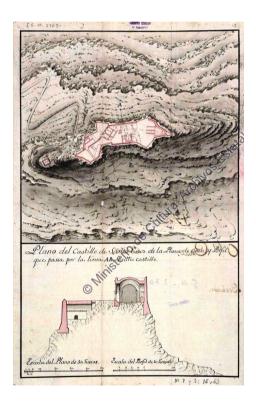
Planta y sección del Castillo de Santa Cruz. Juan Ballester de Verboom, 1732 (AGS)
